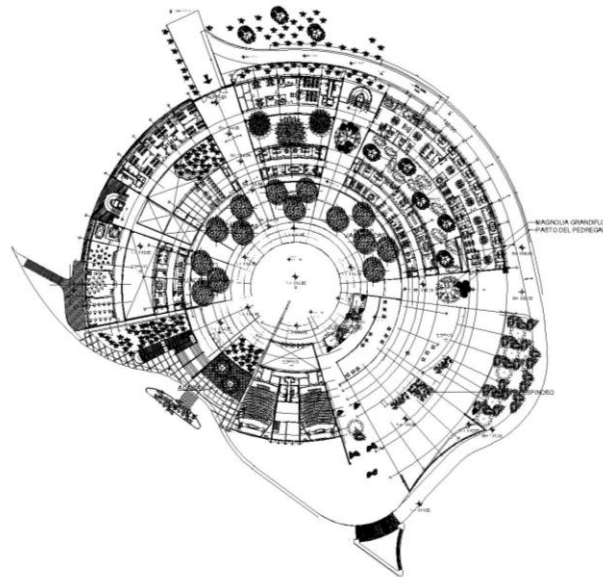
Plano original de la unidad de posgrado. Planta baja.
